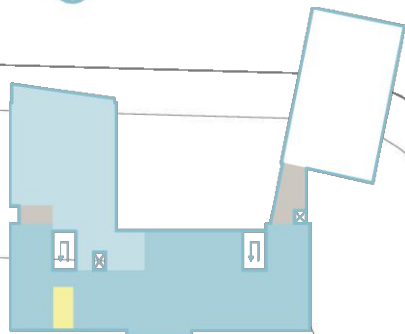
Schema Adaptierung und Erweiterung: Grundriss 2. Obergeschoß.
